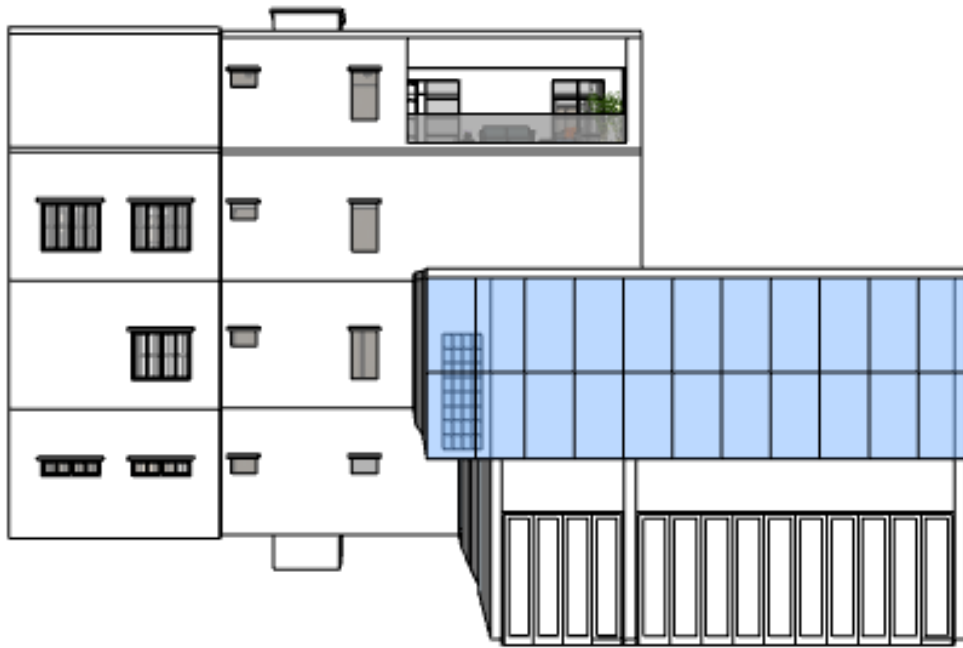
Tampak Samping Denah Tiga Dimensi Rumah Kantor Empat Lantai
